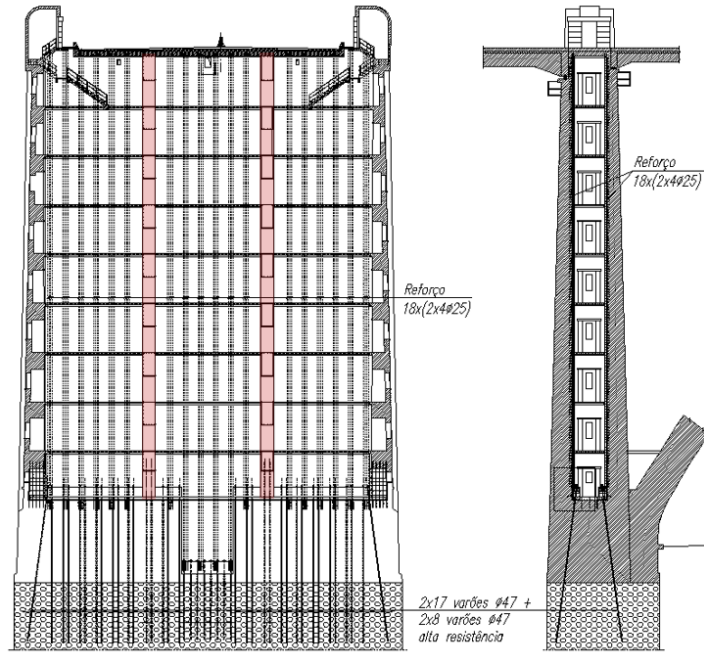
Corte longitudinal e transversal das pilastras ilustrando a solução de reforço.
